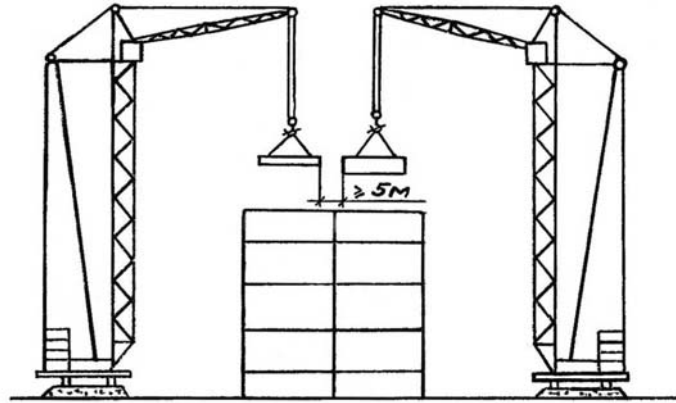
Схема одночасного монтажу конструкцій будівлі двома баштовими кранами (розріз 1-1 до рис. 4.10)
